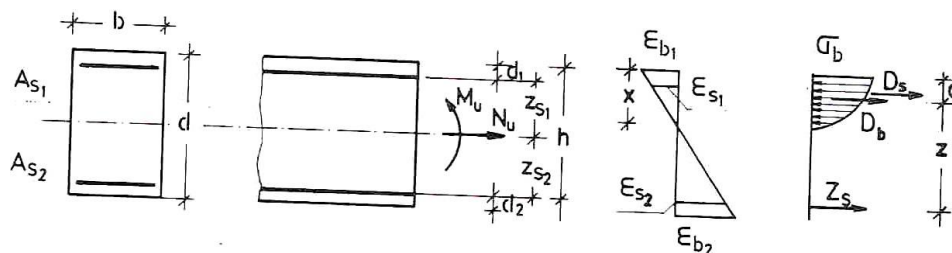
Flexión de elementos estructurales de hormigón armado.
